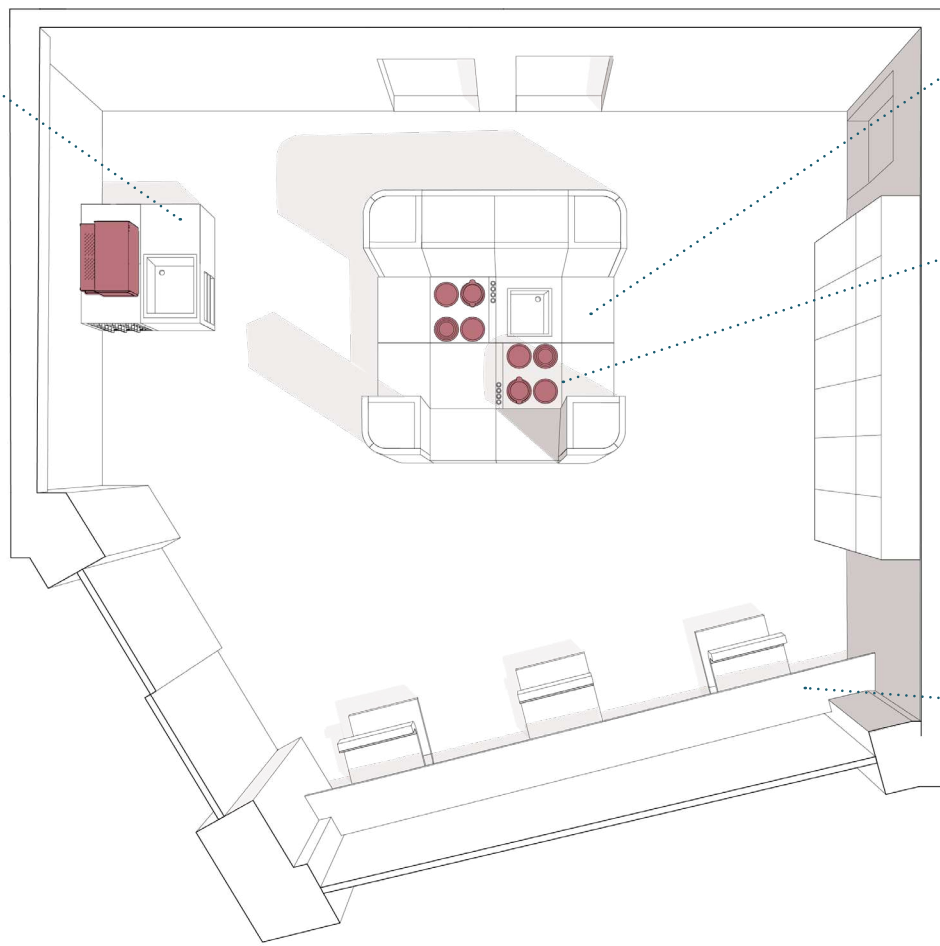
Grundriss - Koch- und Essbereich
